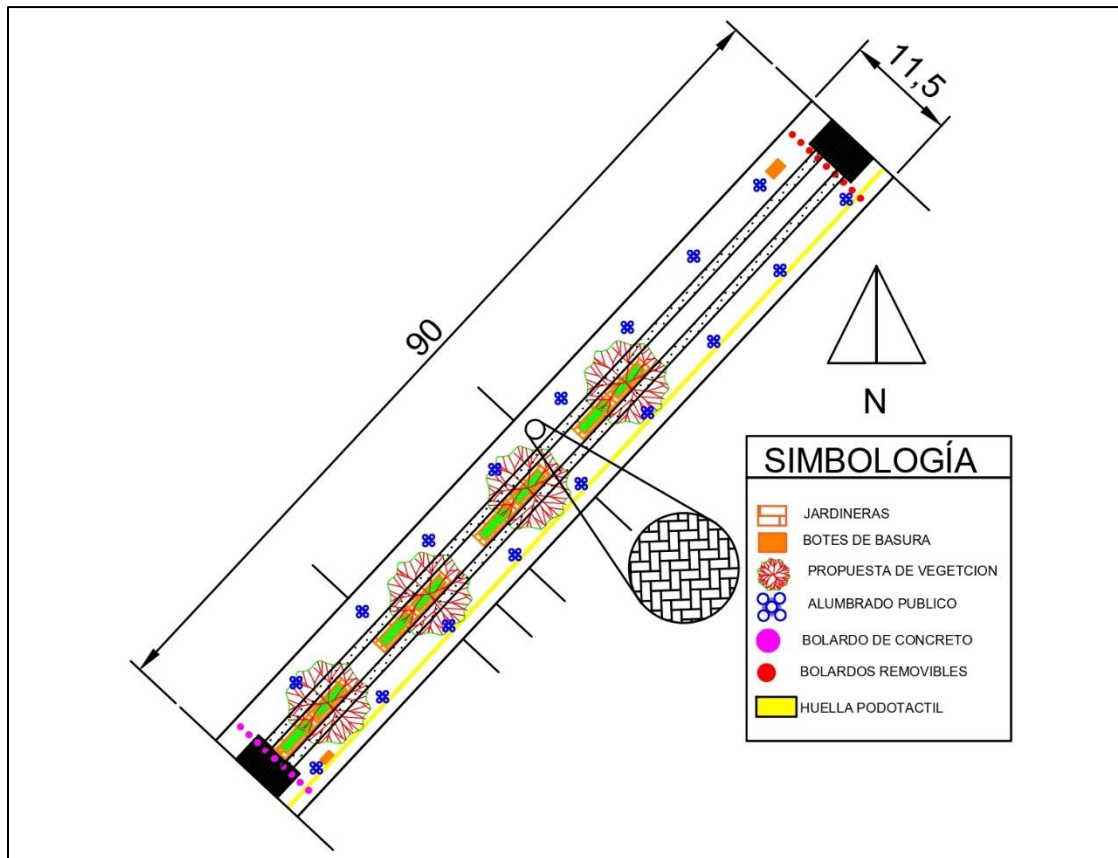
Vista en planta de la propuesta para la calle 1 entre las avenidas 3 y 5.
